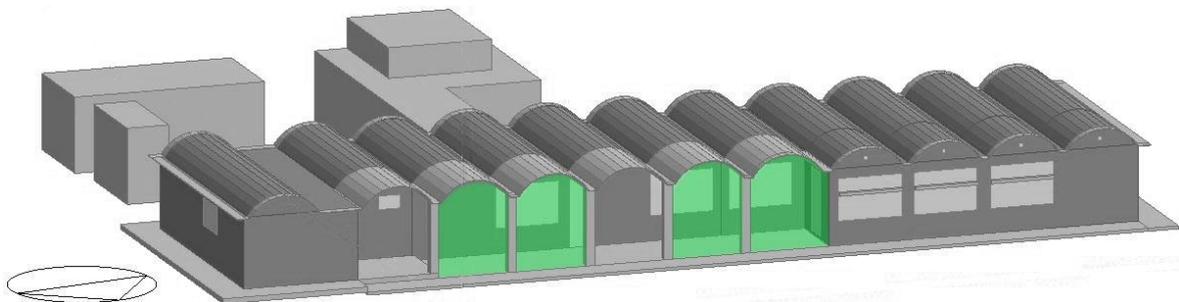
Vista esquemática fachada Norte Escuela 30 con aberturas modificadas y uso de vegetación en galería de acceso.
